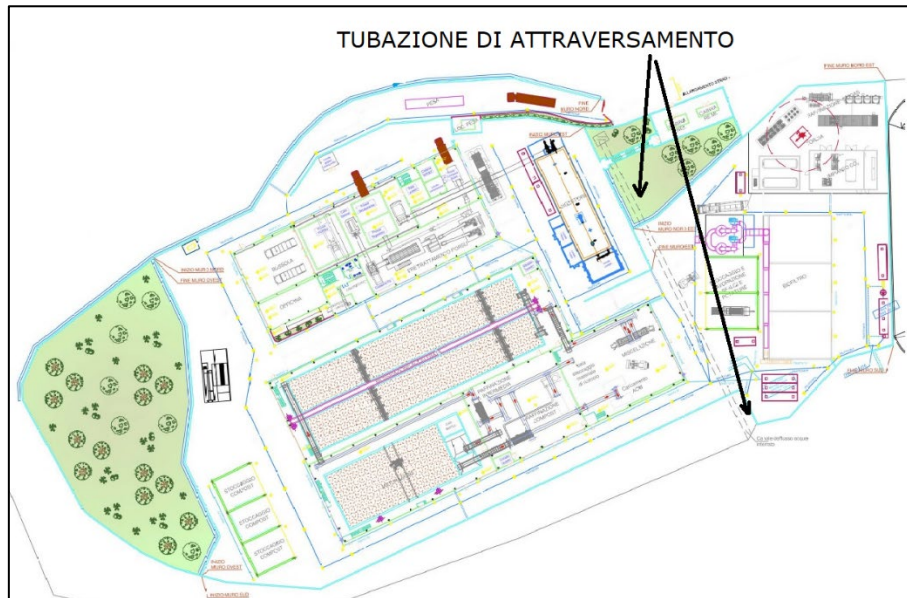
Posizione attraversamento con tubazione scarico acque meteoriche provenienti da monte
